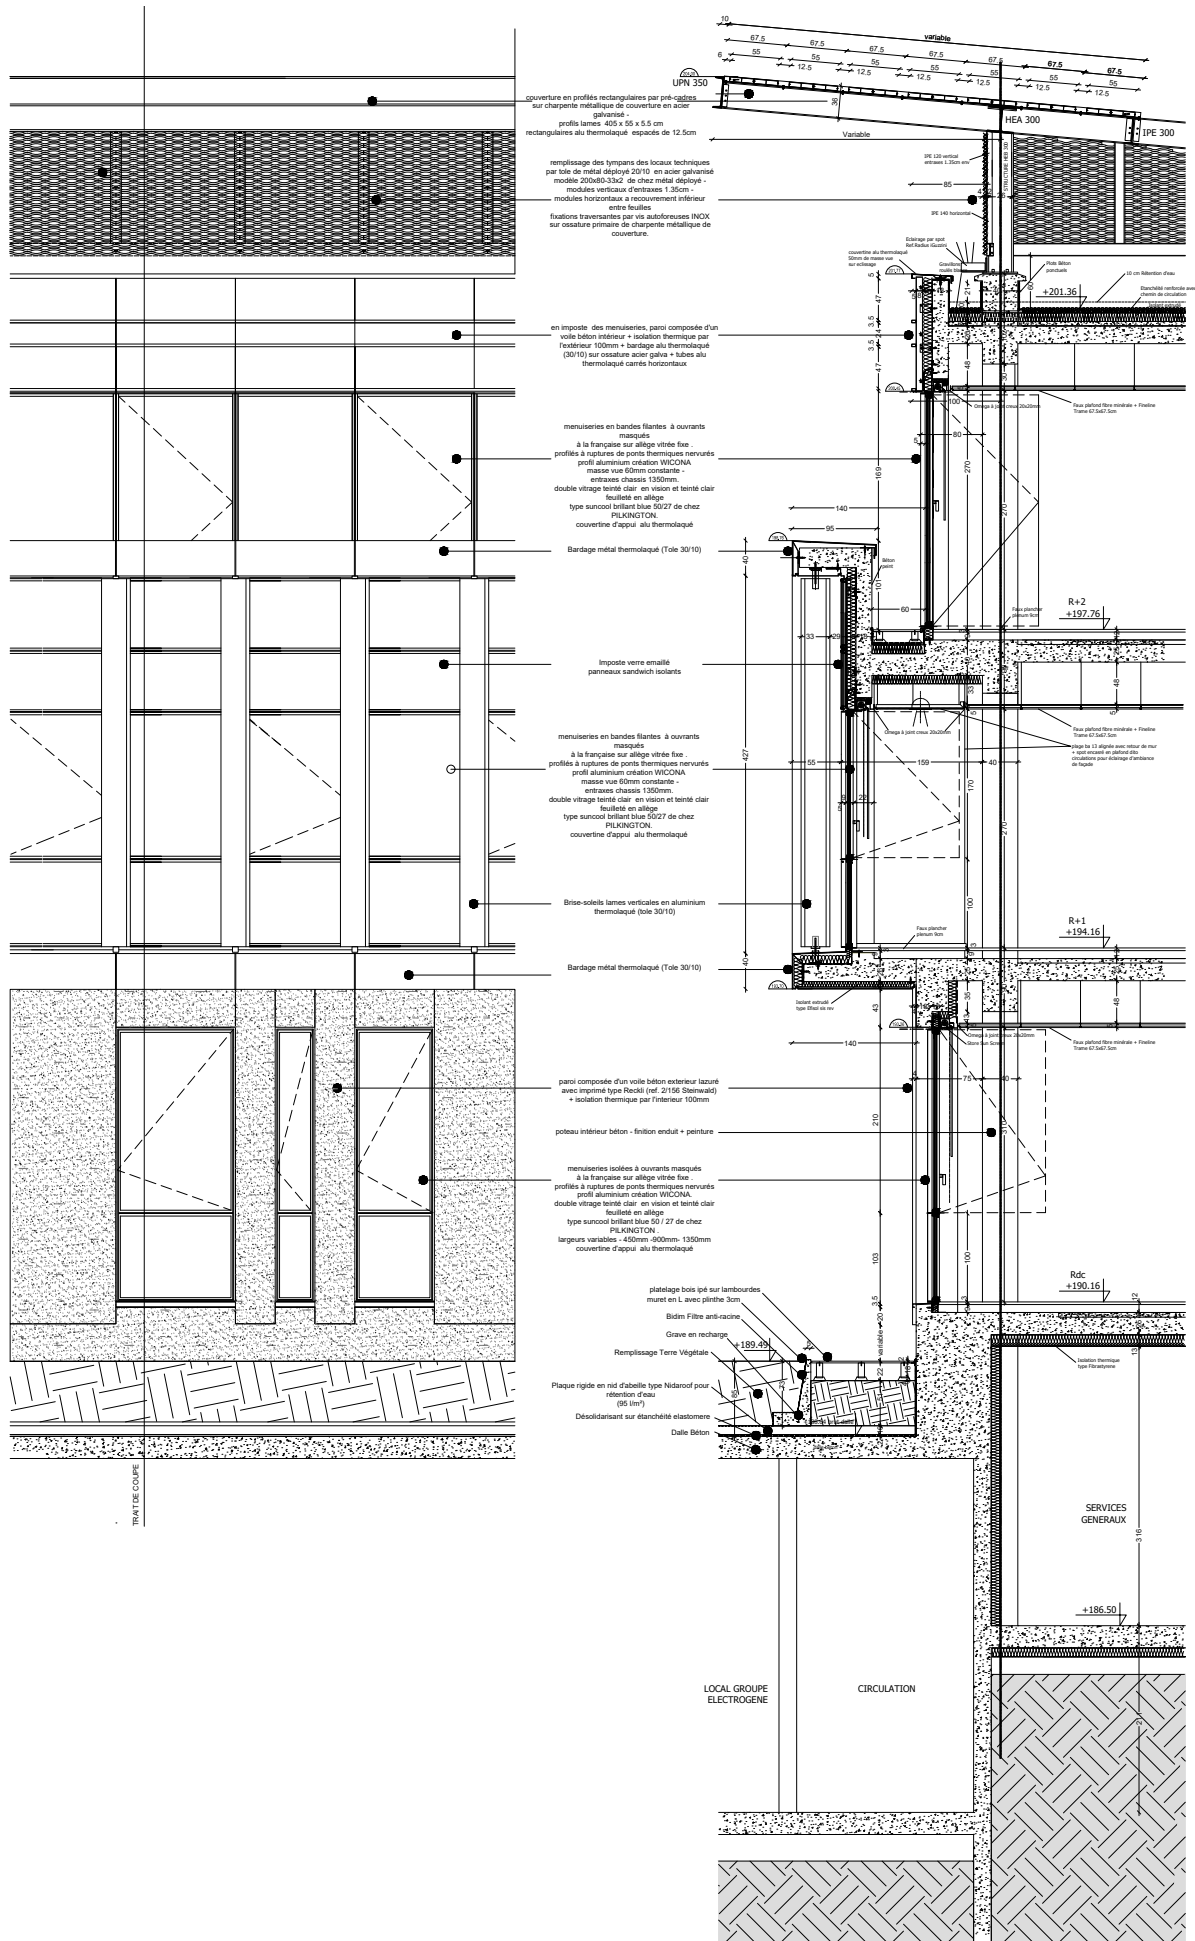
/03/04/05 SUR EBRASEMENTS ECH 1/10
